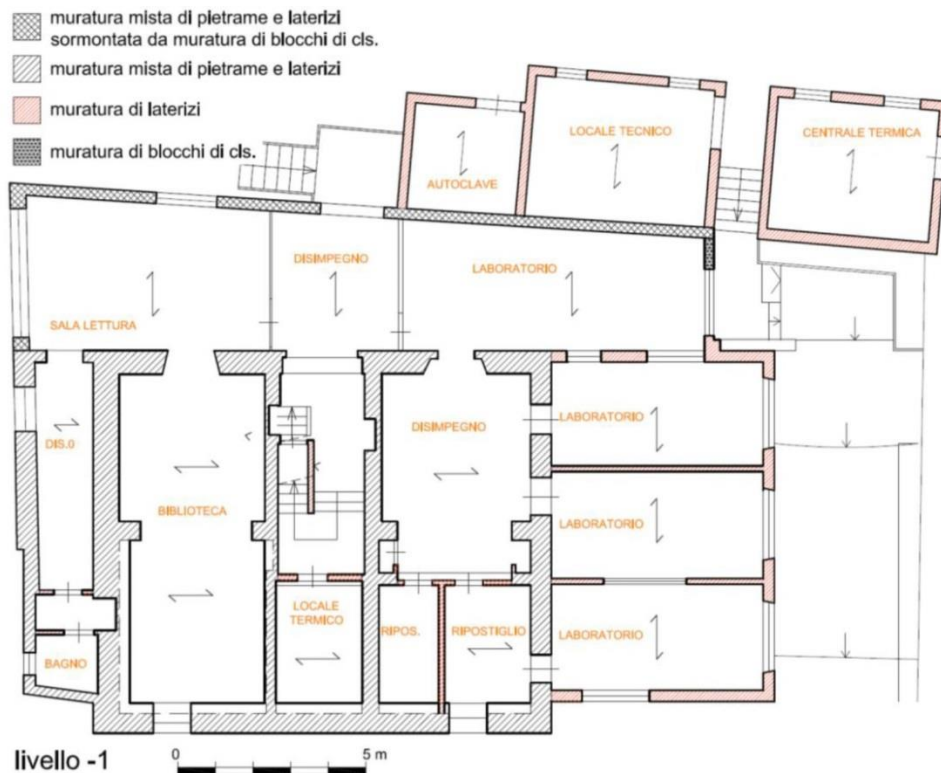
Sezione al piano seminterrato con le tipologie murarie rilevate.
